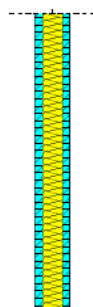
Pormenor da parede interior – Par\_Int\_3.
